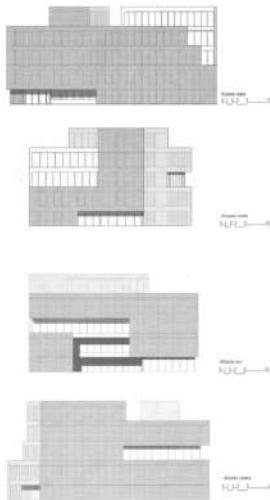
3 de las fachadas exteriores\_TC cuadernos
